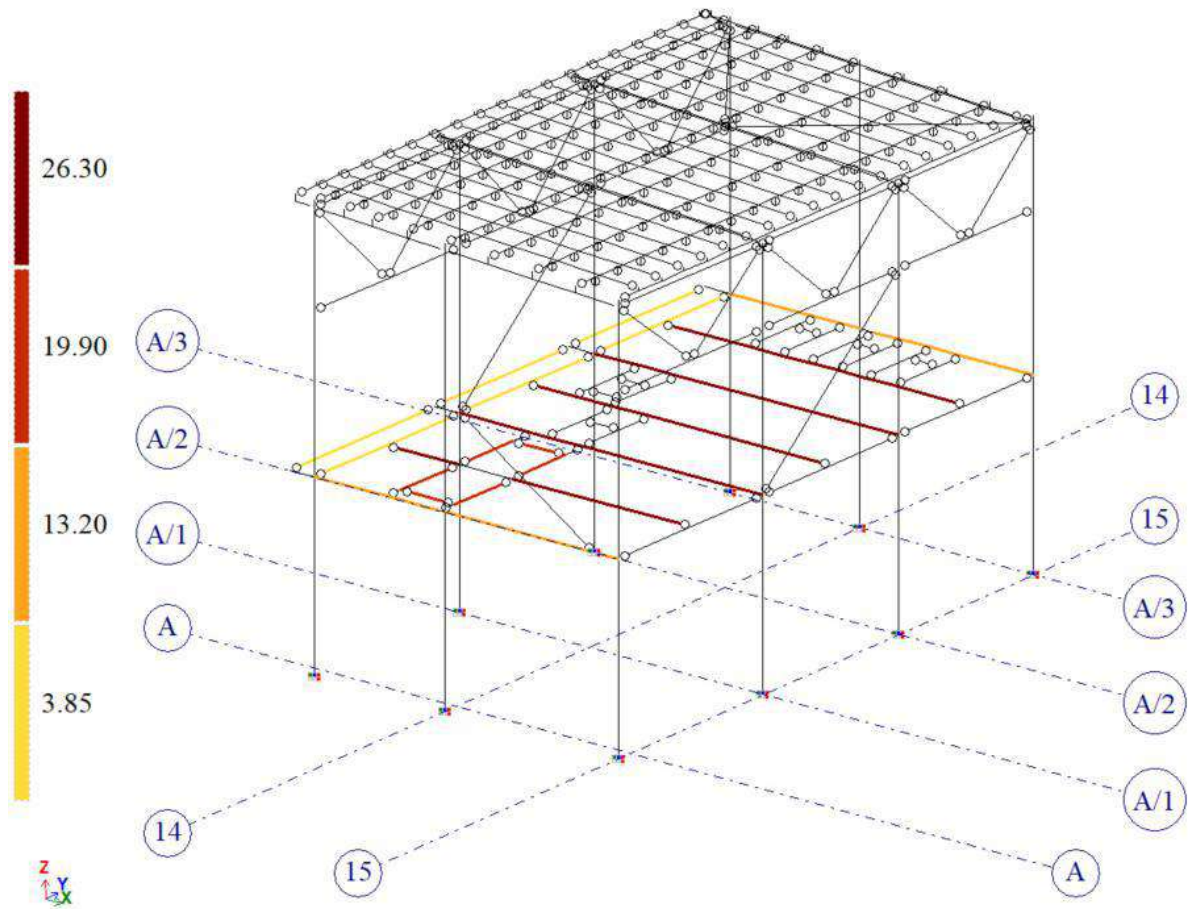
Нагрузка от собственного веса конструкции пере-
